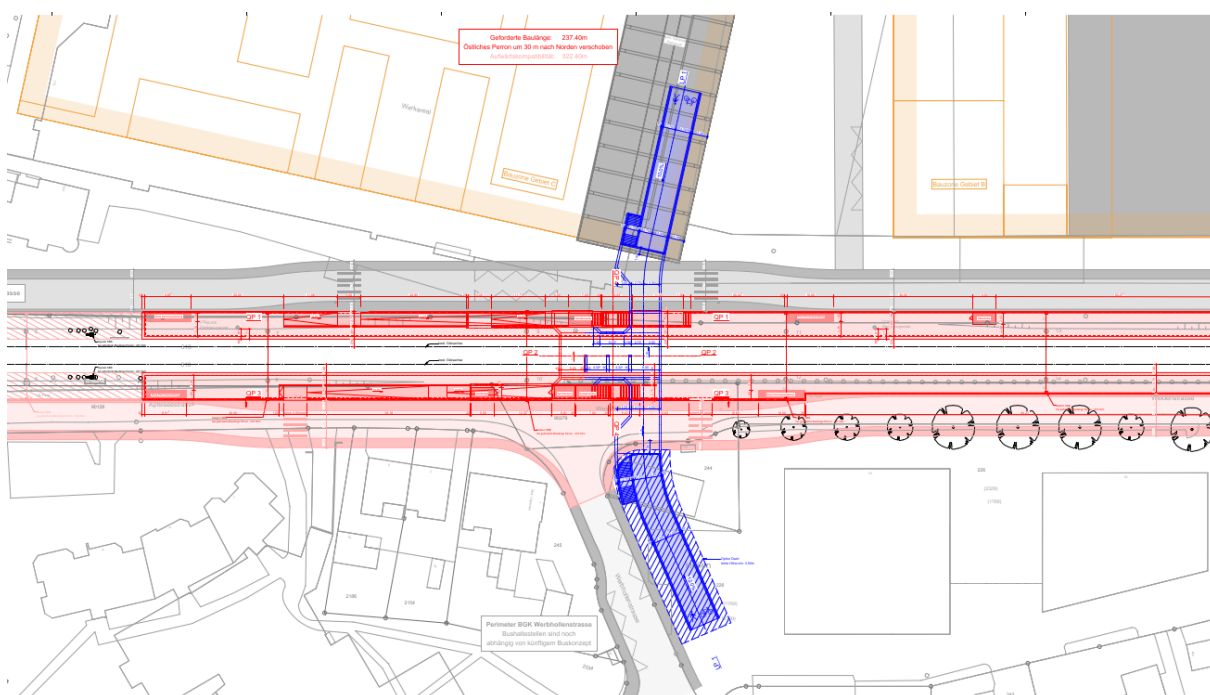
Grundriss funktionale Bestvariante neue Haltestelle Dornach Apfelsee mit funktionaler Bestvariante Option Langsamverkehrsunterführung Dritter (inkl. Zusammenschluss in der PU Bahn) [4]
